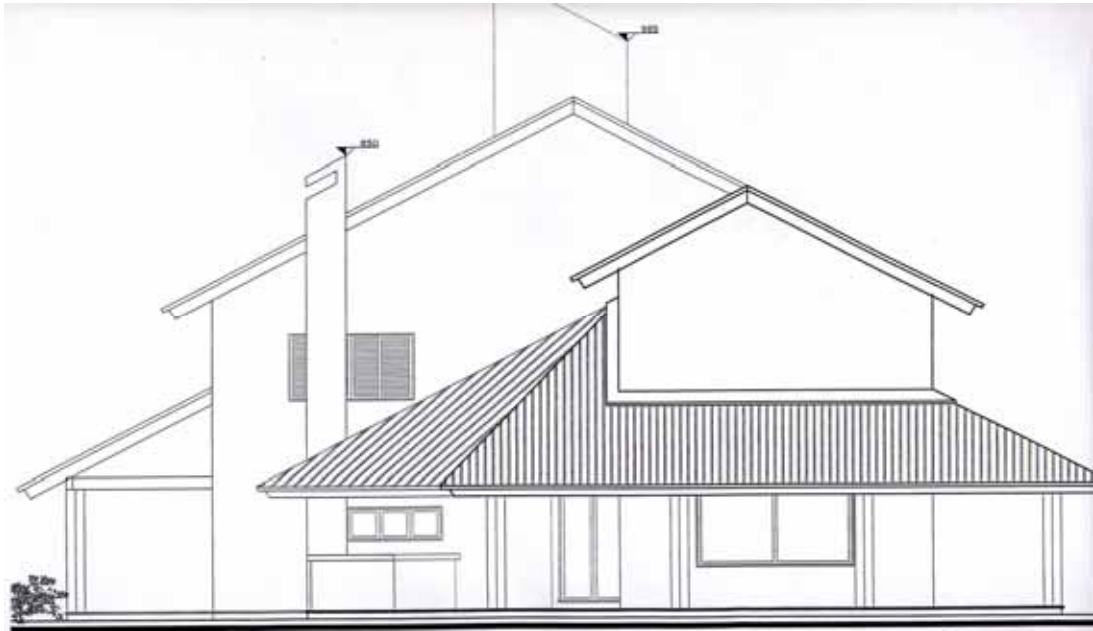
Projeto Estudo de Caso 1 - Fachadas Norte
